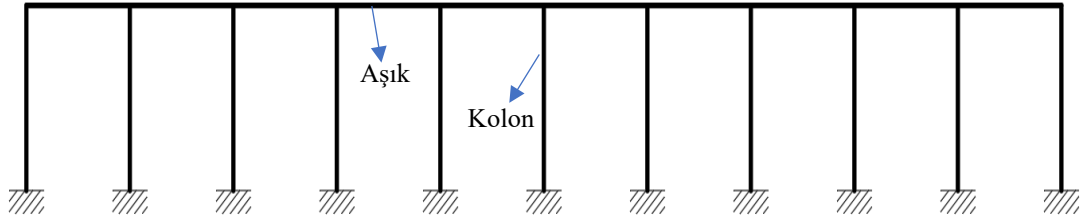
Endüstriyel hangar tipi çelik yapının kat planı ve taşıyıcı elemanları.
